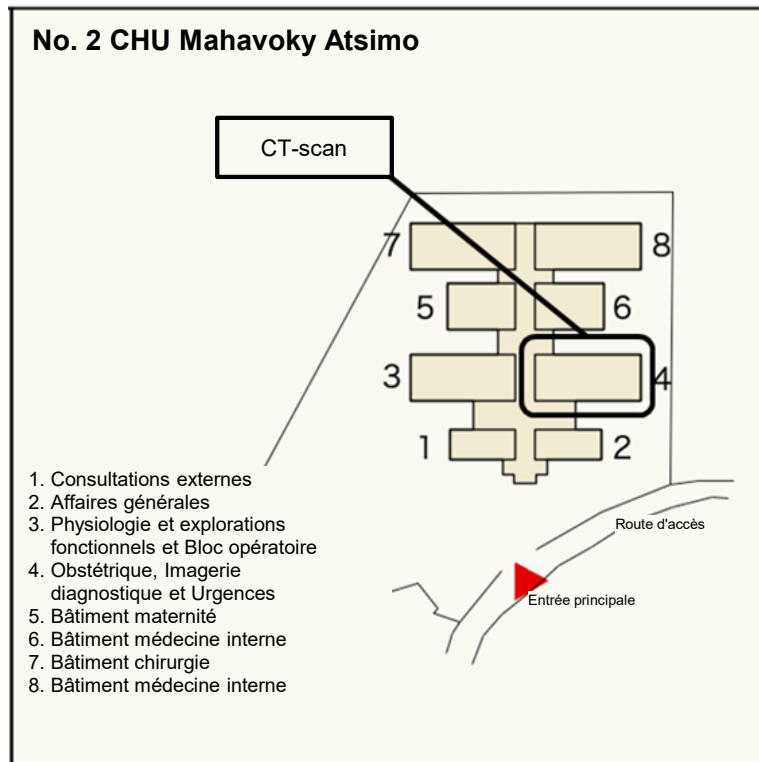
Plan d'implantation du CHU Mahavoky Atsimo
